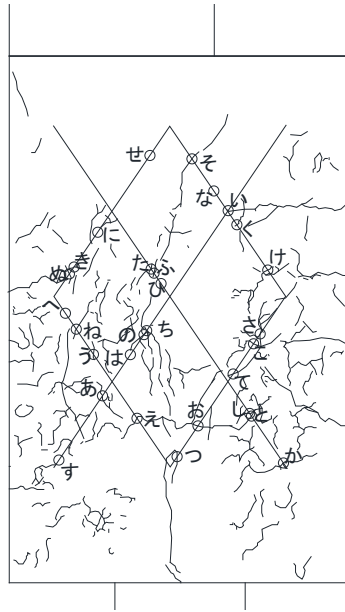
パイルキャップひび割れ幅測定位置(試験体 C-3 正載荷)
